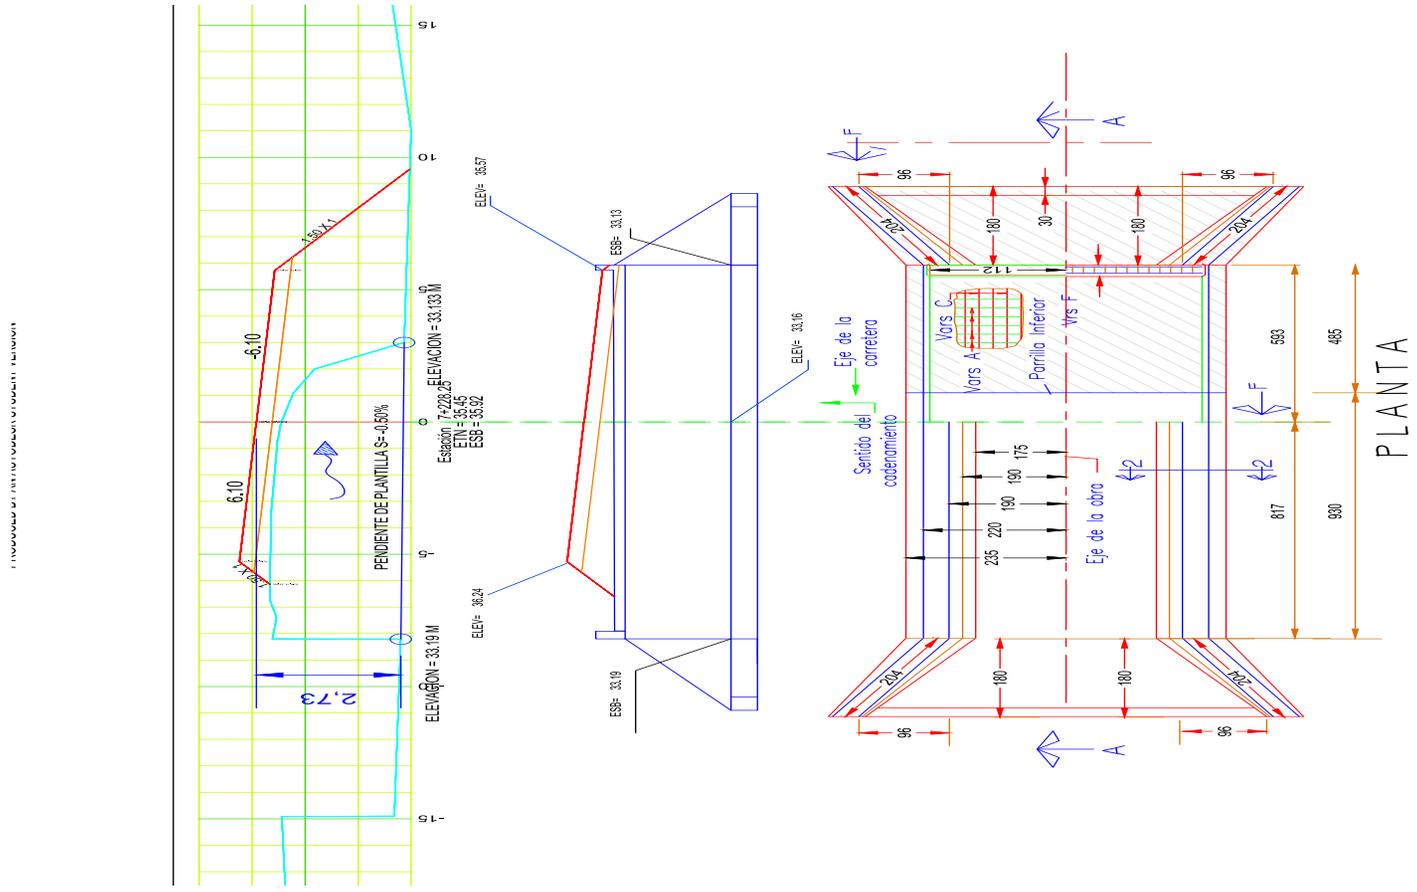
Sección estructural en planta para losas de 3.8 x 2 metros
